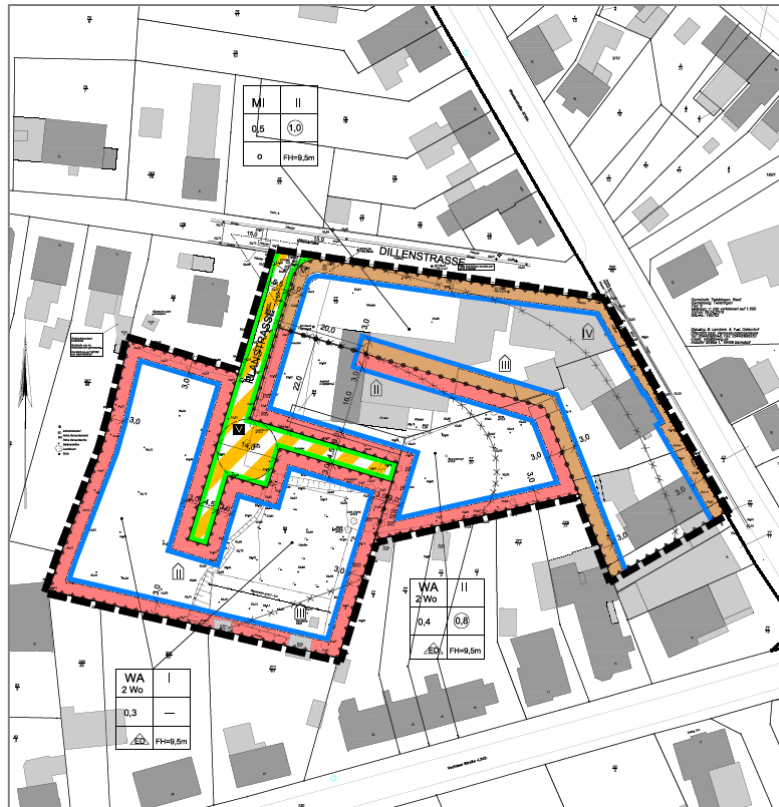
Rechtsgültiger Bebauungsplan Nr. 54 „Südlich der Dillenstraße“
